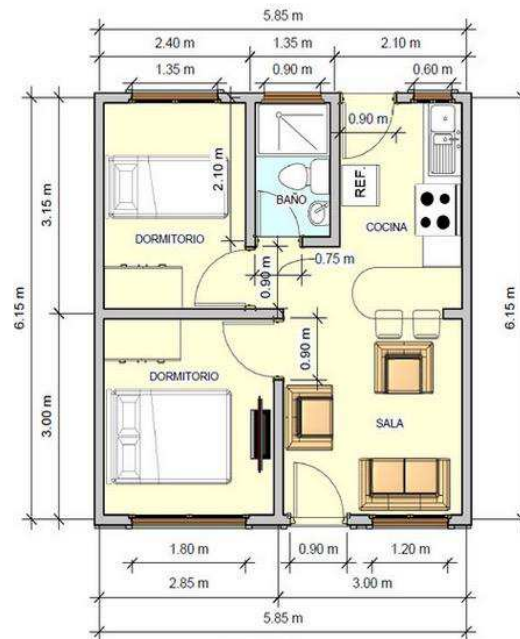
Proyecto de vivienda de interés social “Barrio Buenaventura” – Planta arquitectónica
